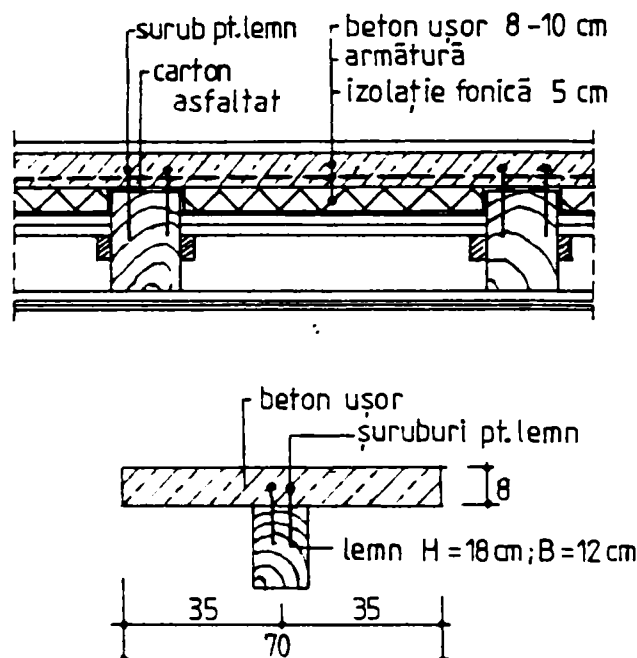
Placă din beton ușor și conlucrare prin șuruburi
